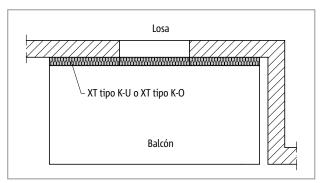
Schöck Isokorb® XT tipo K-U/ K-O: Balcón en fachada saliente
